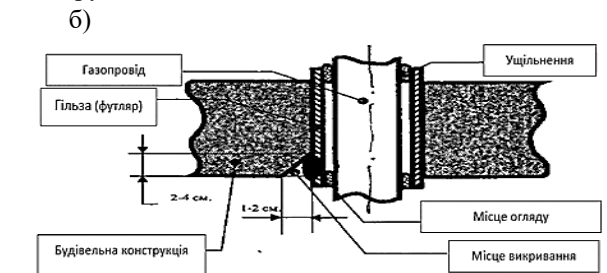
Розкриття ділянки газопроводу в місці переходу через будівельну конструкцію в разі, коли футляр повністю оберігає поверхню газової труби від контакту з будівельною конструкцією.
